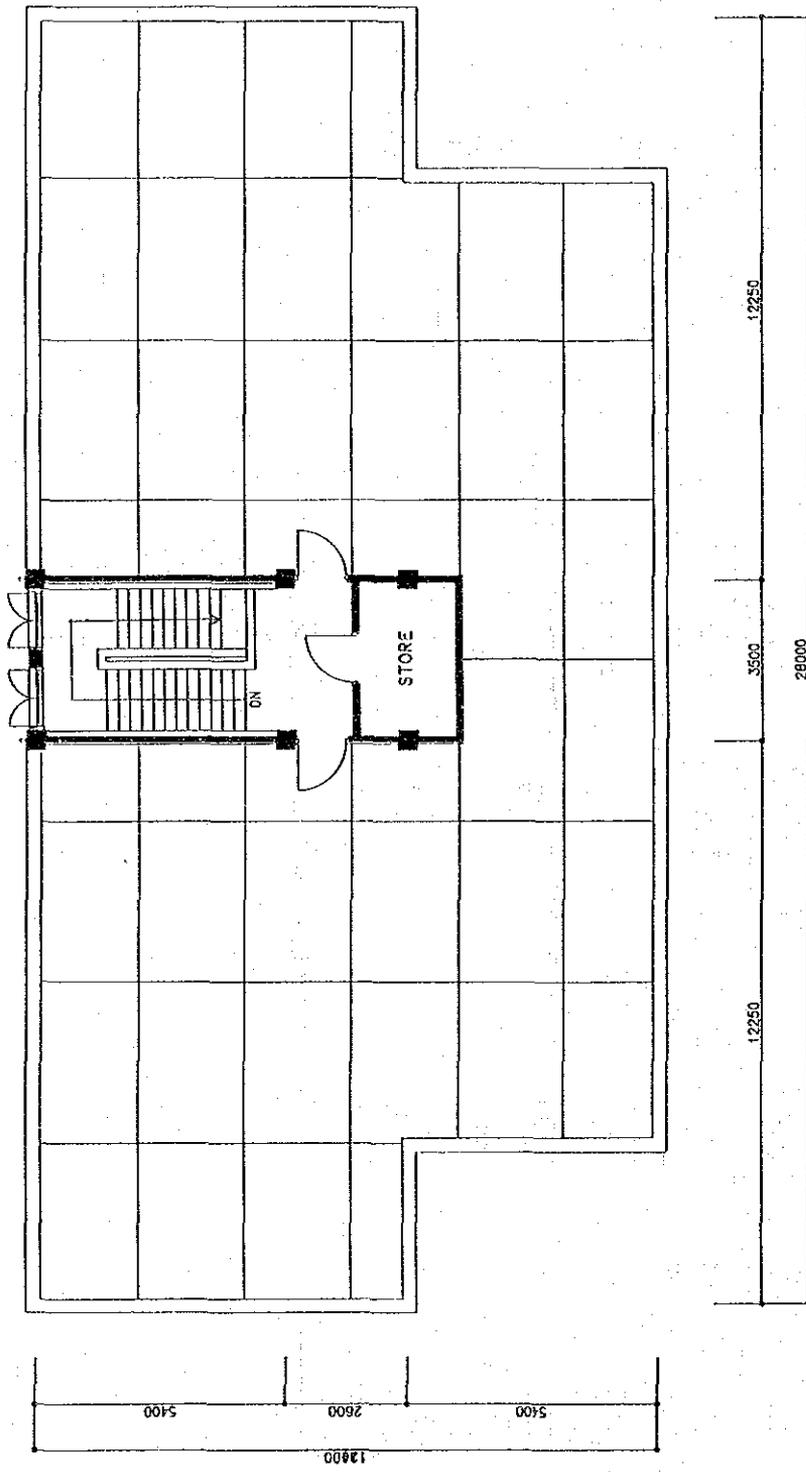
(3) 屋階平面図 (5 教室タイプ)
